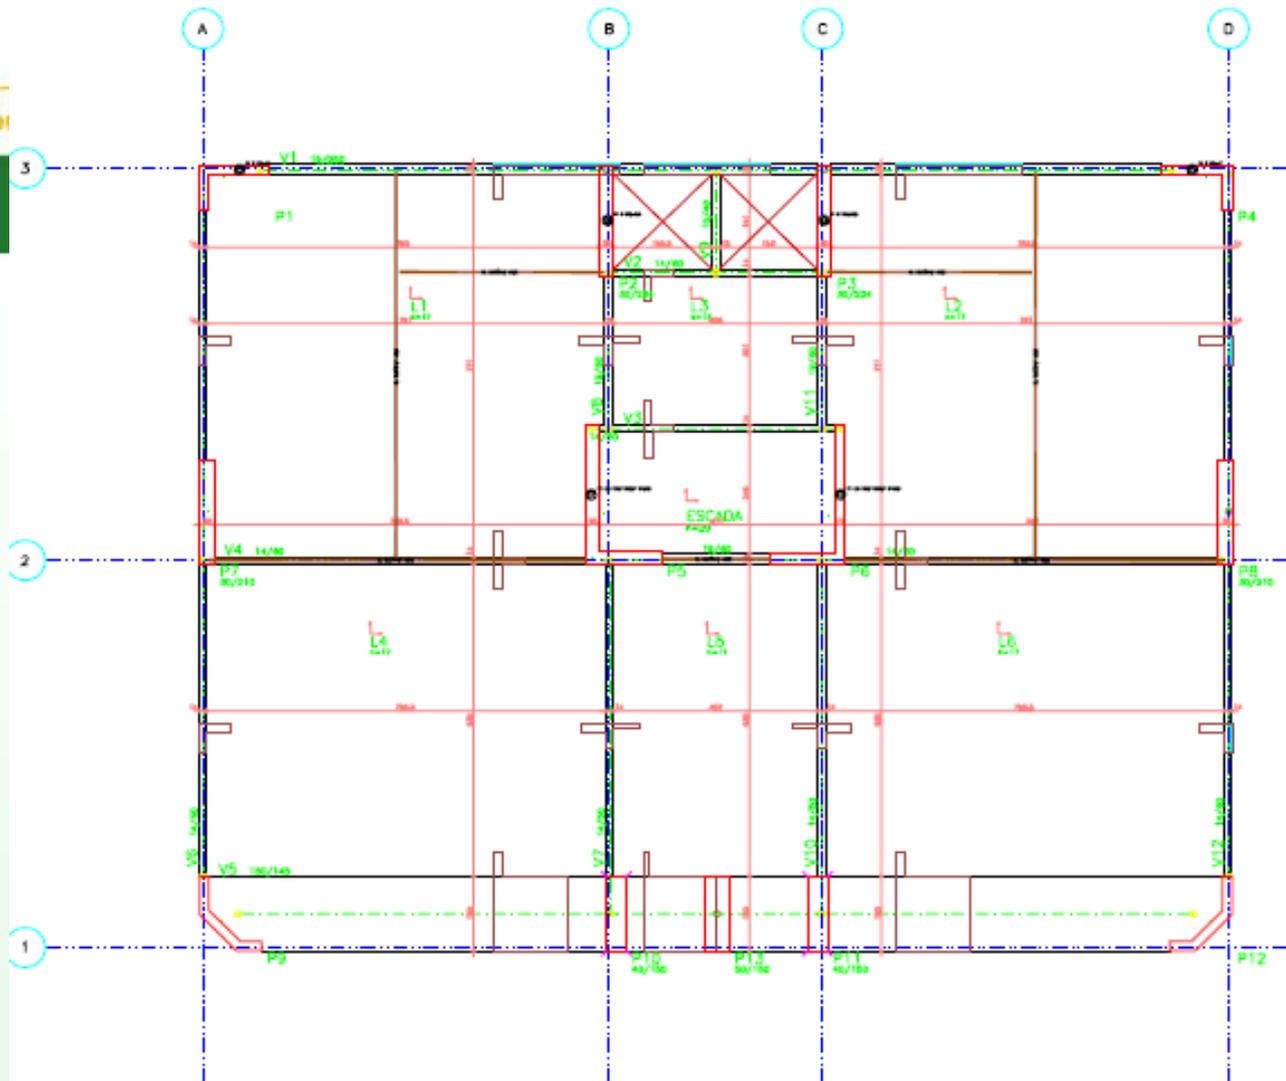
Planta do pavimento tipo da estrutura adotada no desenvolvimento do estudo
